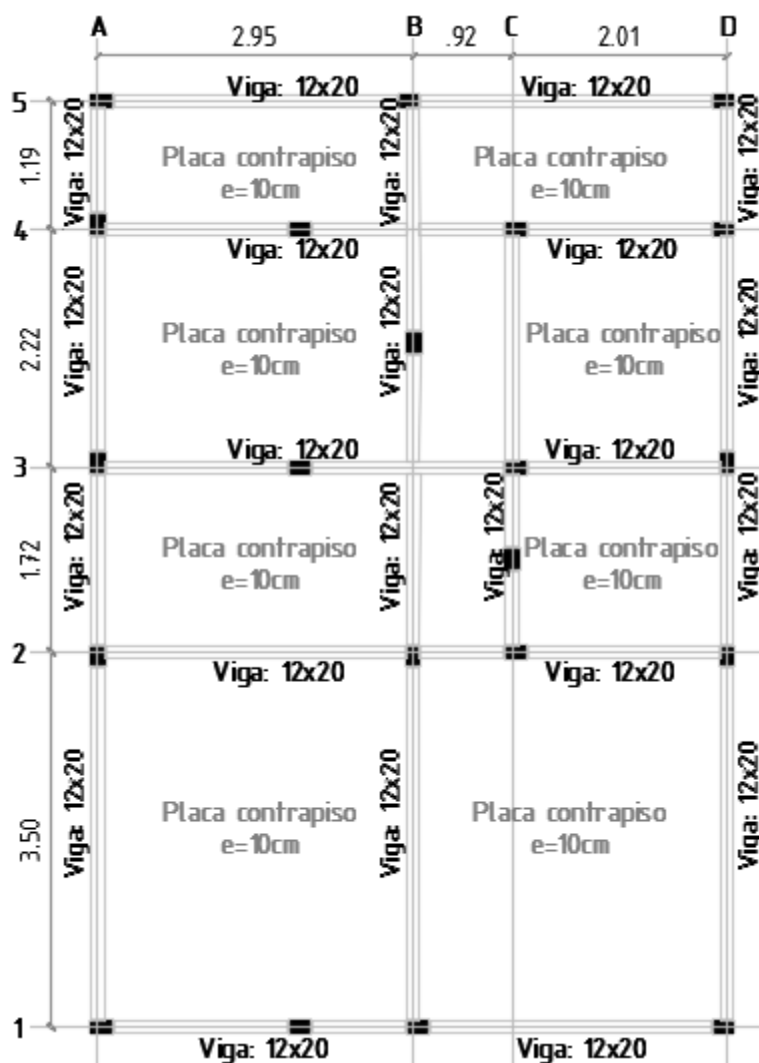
Detalle de cimentación continua para viviendas de mampostería confinada
